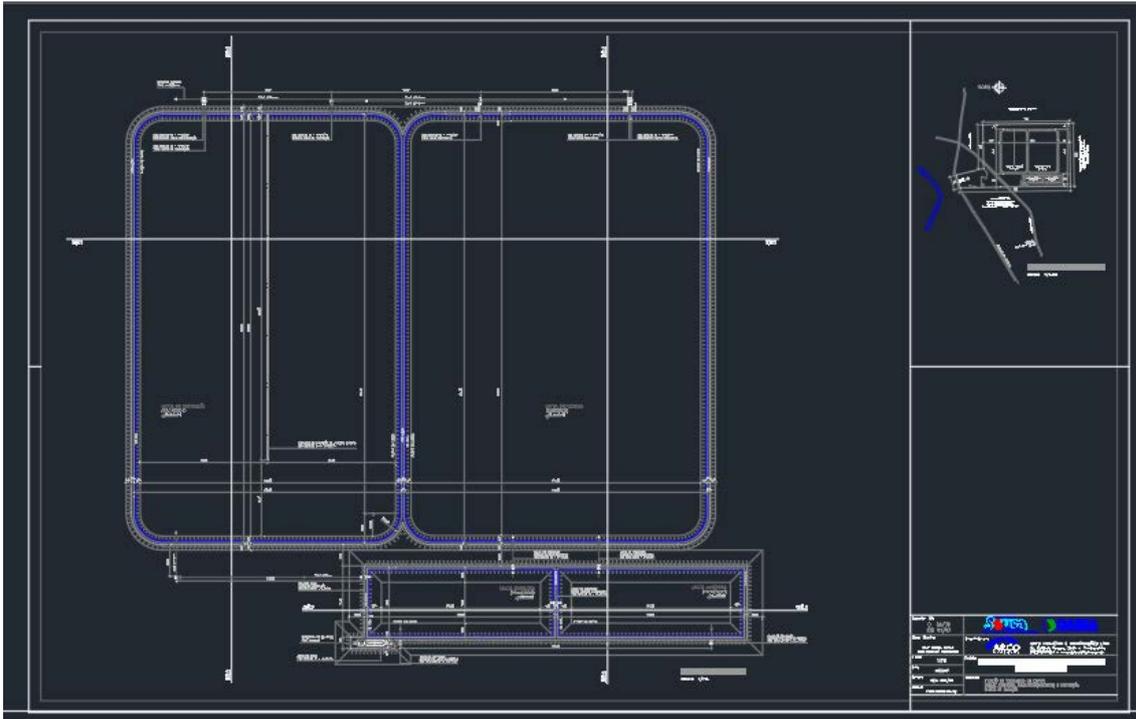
Detalhamento da ETE cuja qual será receptora do projeto Canal Vivo. Fonte: DAESA.
